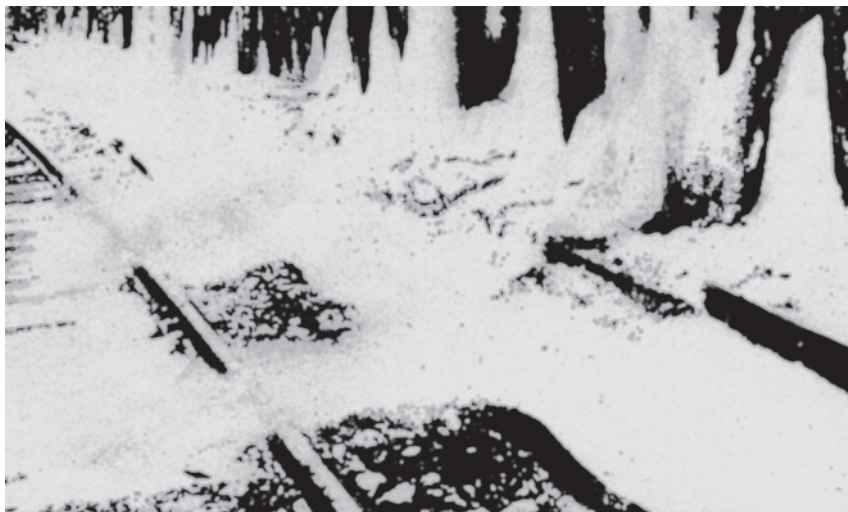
Образование откосной наледи при выходе грунтовой воды в откосе и льдообразованиях в кюветах, на обочине, рельсошпальной решетке
